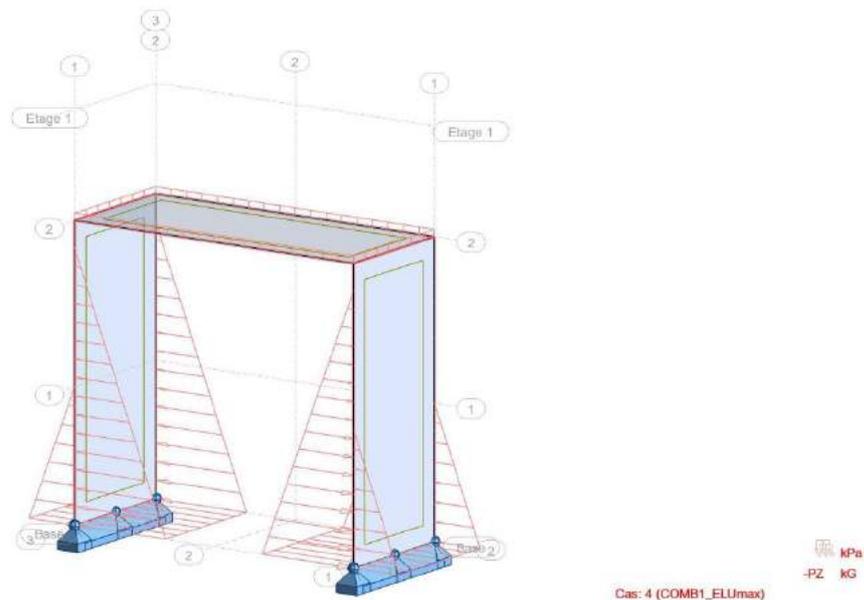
Passerelles – Modèle de la rampe d'accès en béton armé (avec force de poussée des remblais)
